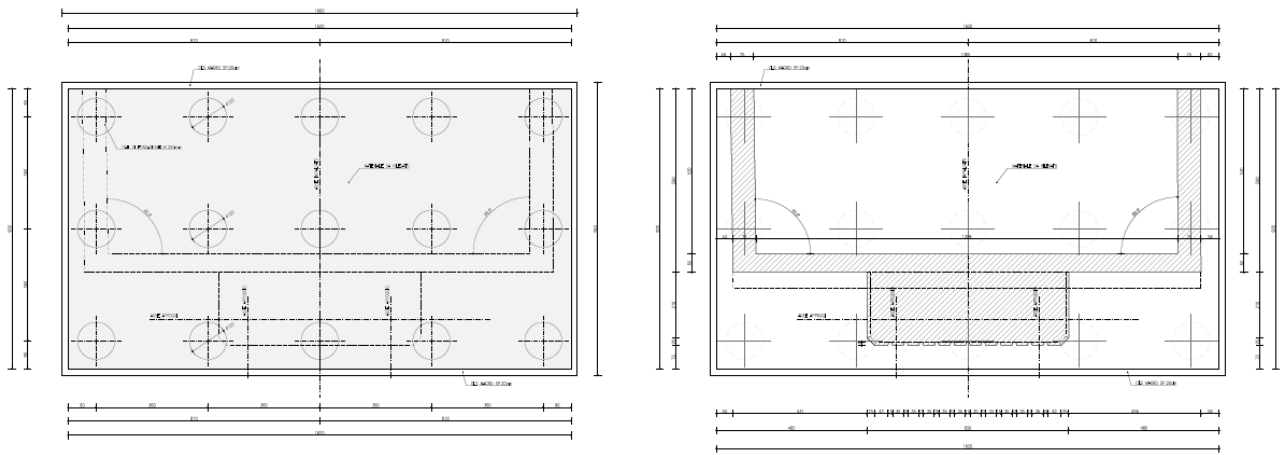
Spalla 1 – carpenteria fondazioni
